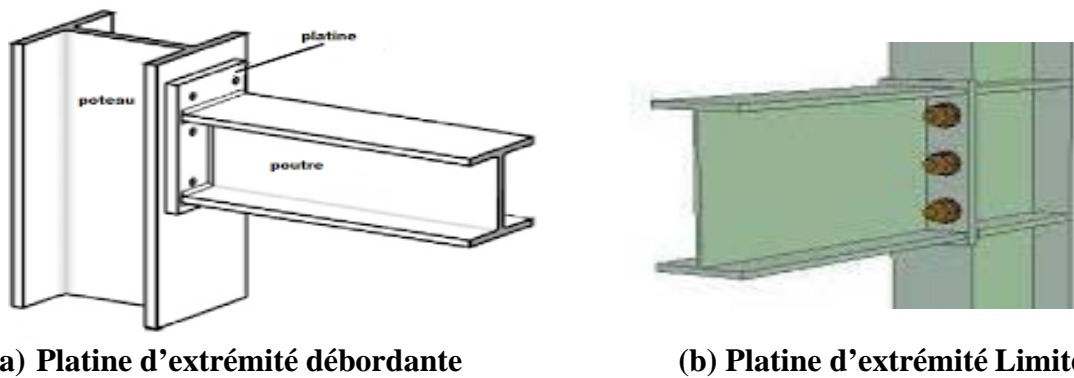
Assemblage poutre poteau par platine d'extrémité débordante ou Limité [3]
